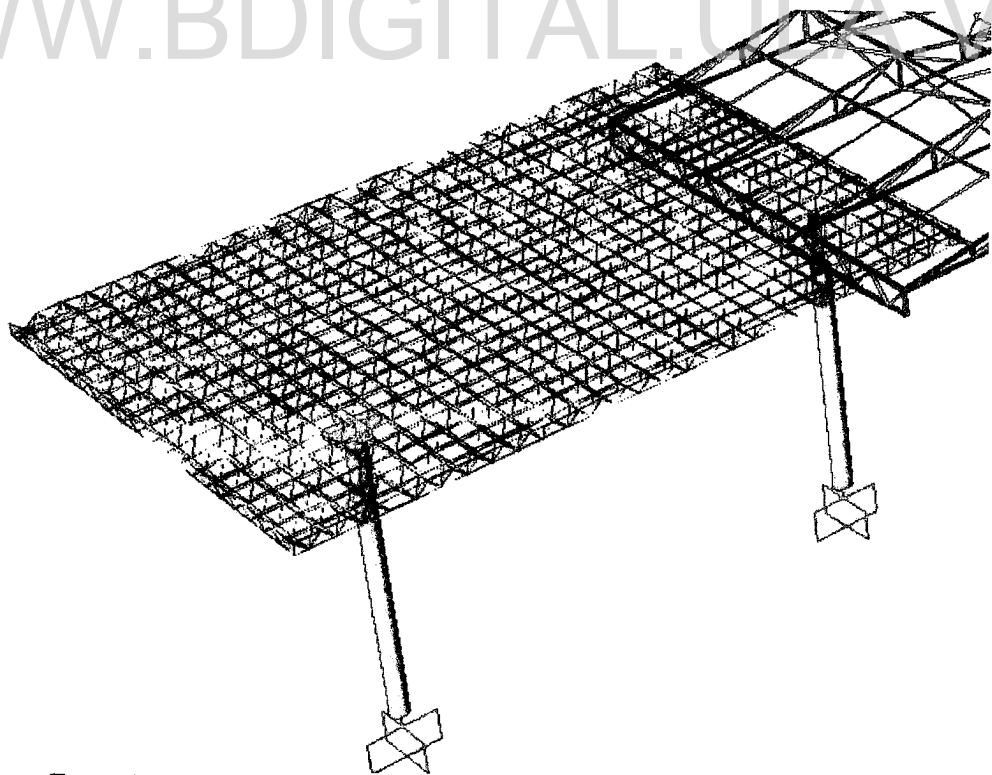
, Detalle modelado de estructura metálica tipo tridilosa pequeña.
